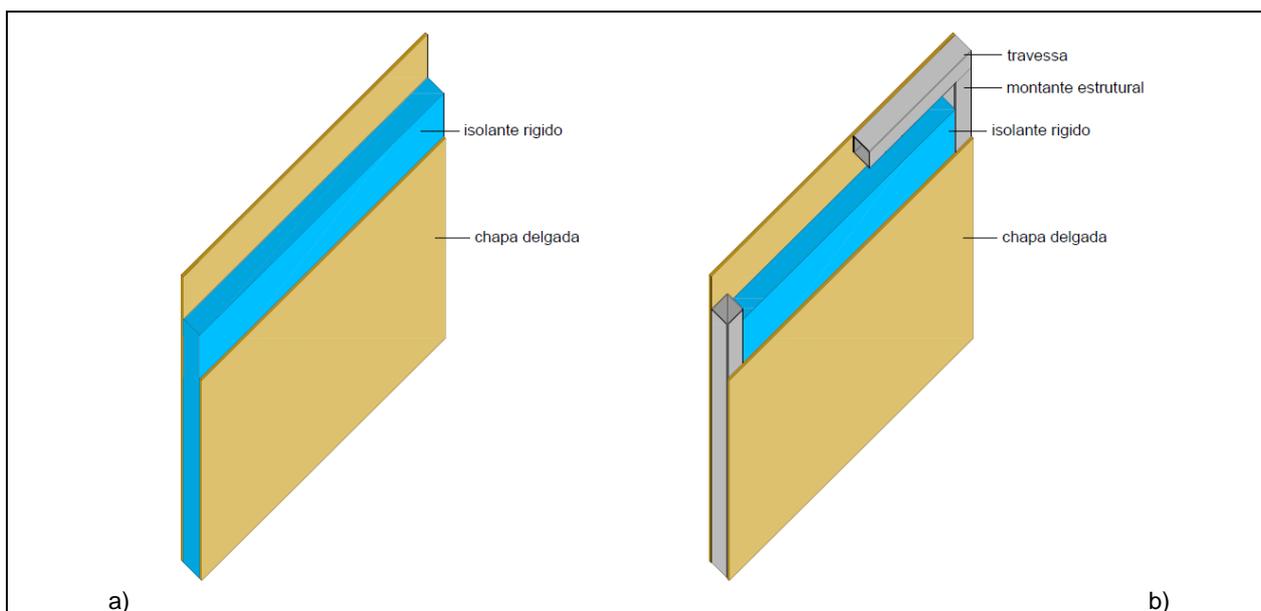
a) painéis estruturais, sem reforços; b) painéis estruturais com perfis de reforços integrados na fase de fabricação
